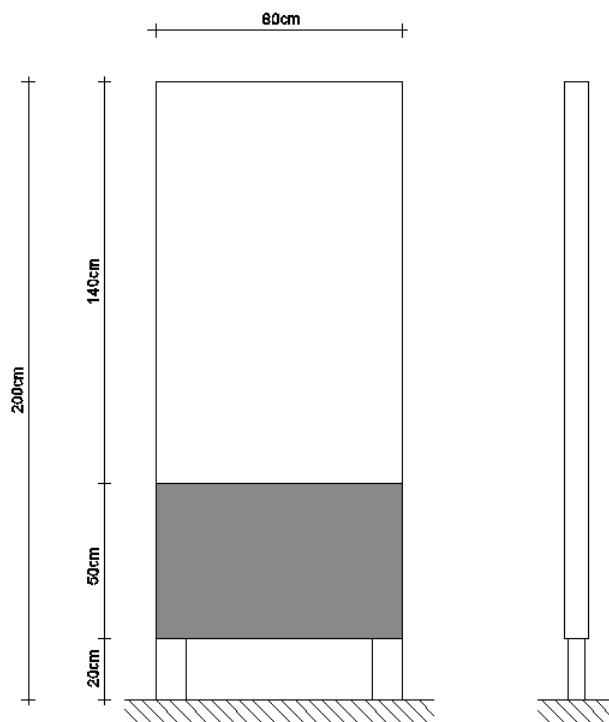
Sinalética de Marcação de Entrada (anexo c.08)
